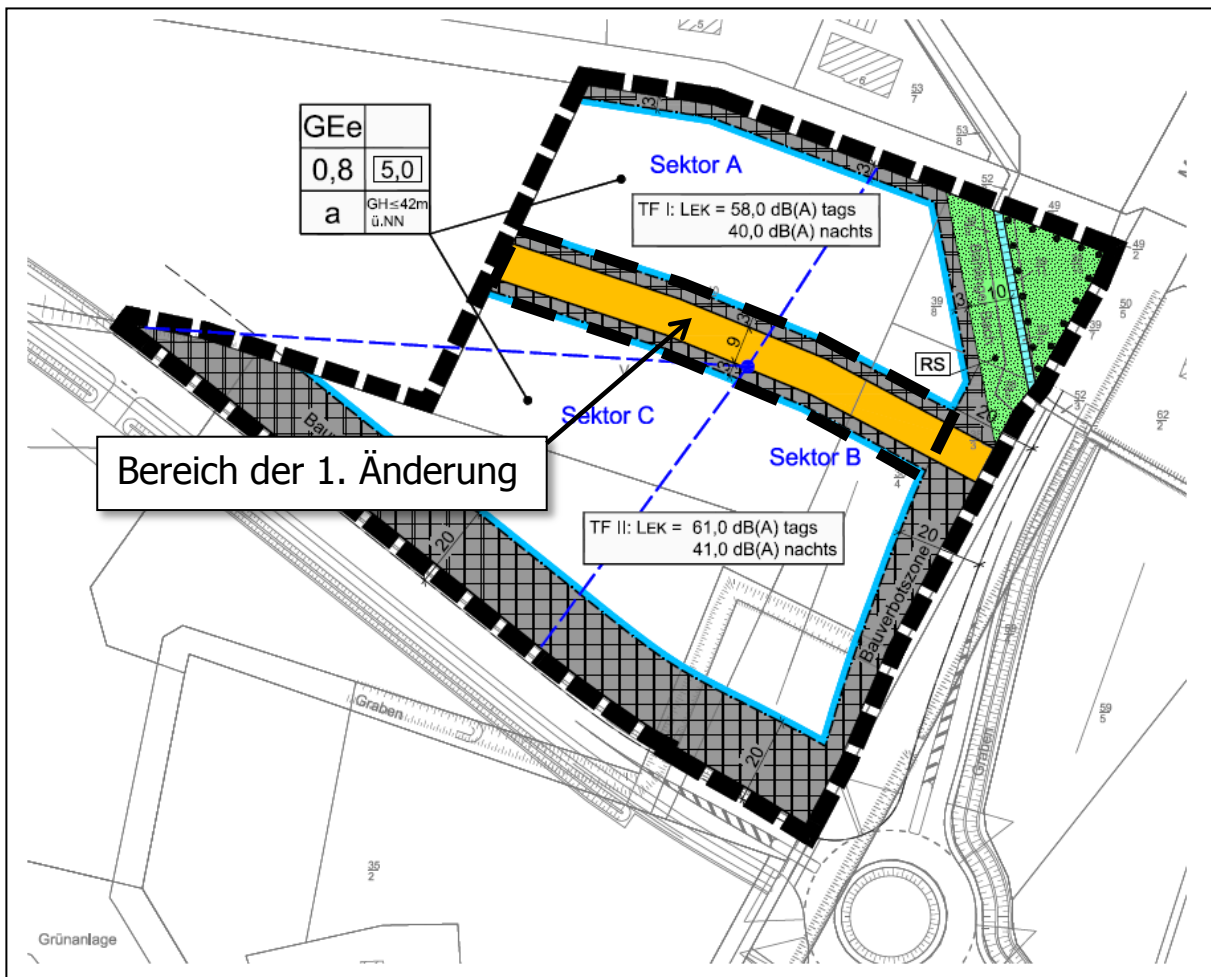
Bestandskräftiger Bebauungsplan mit eingetragenem Bereich der 1. Änderung
